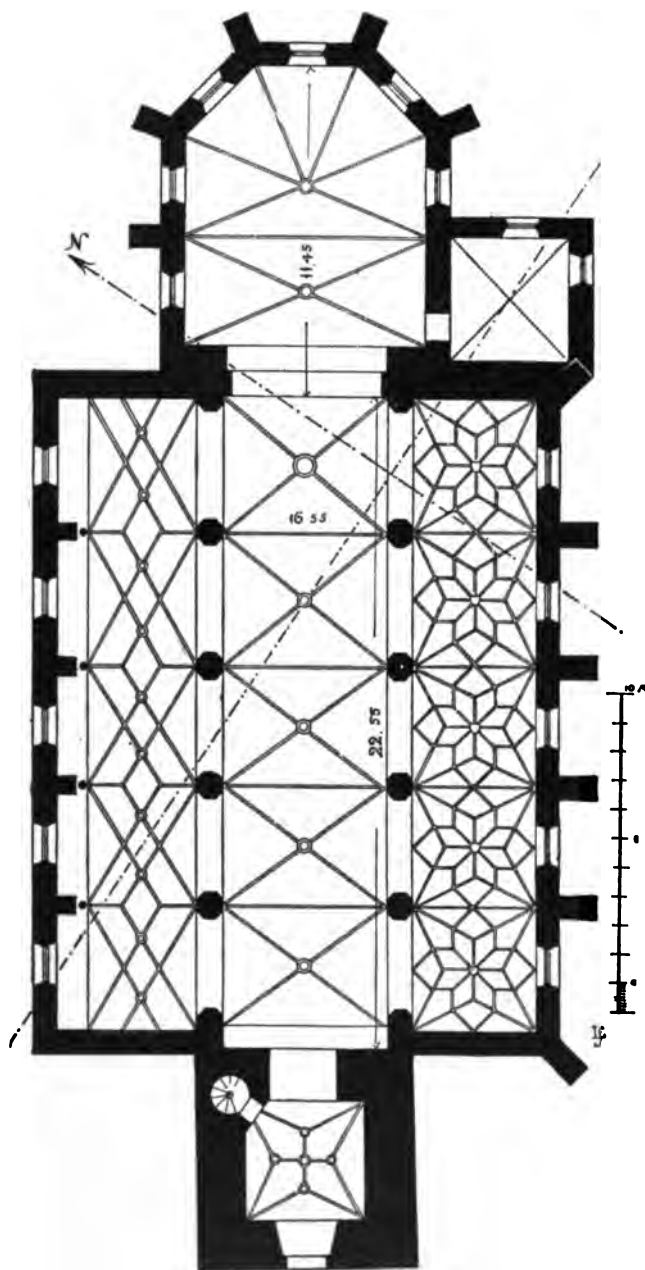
Erbach. Pfarrkirche. Grundriss.
